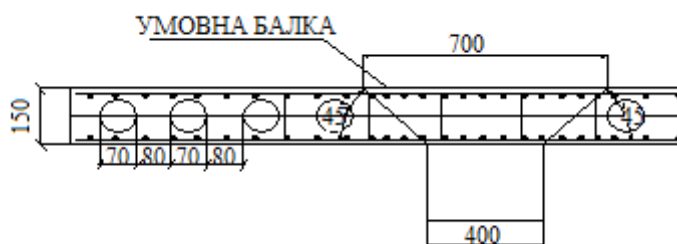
Поперечний переріз плити перекриття товщиною 150 мм
